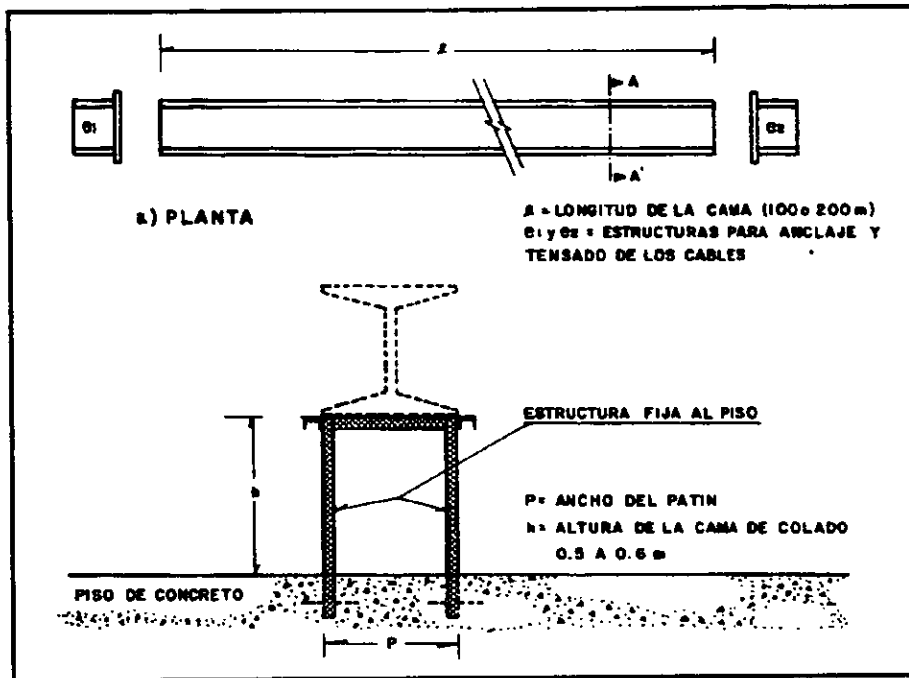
Cama para tensado y colado de pilotes presfuerzados.
